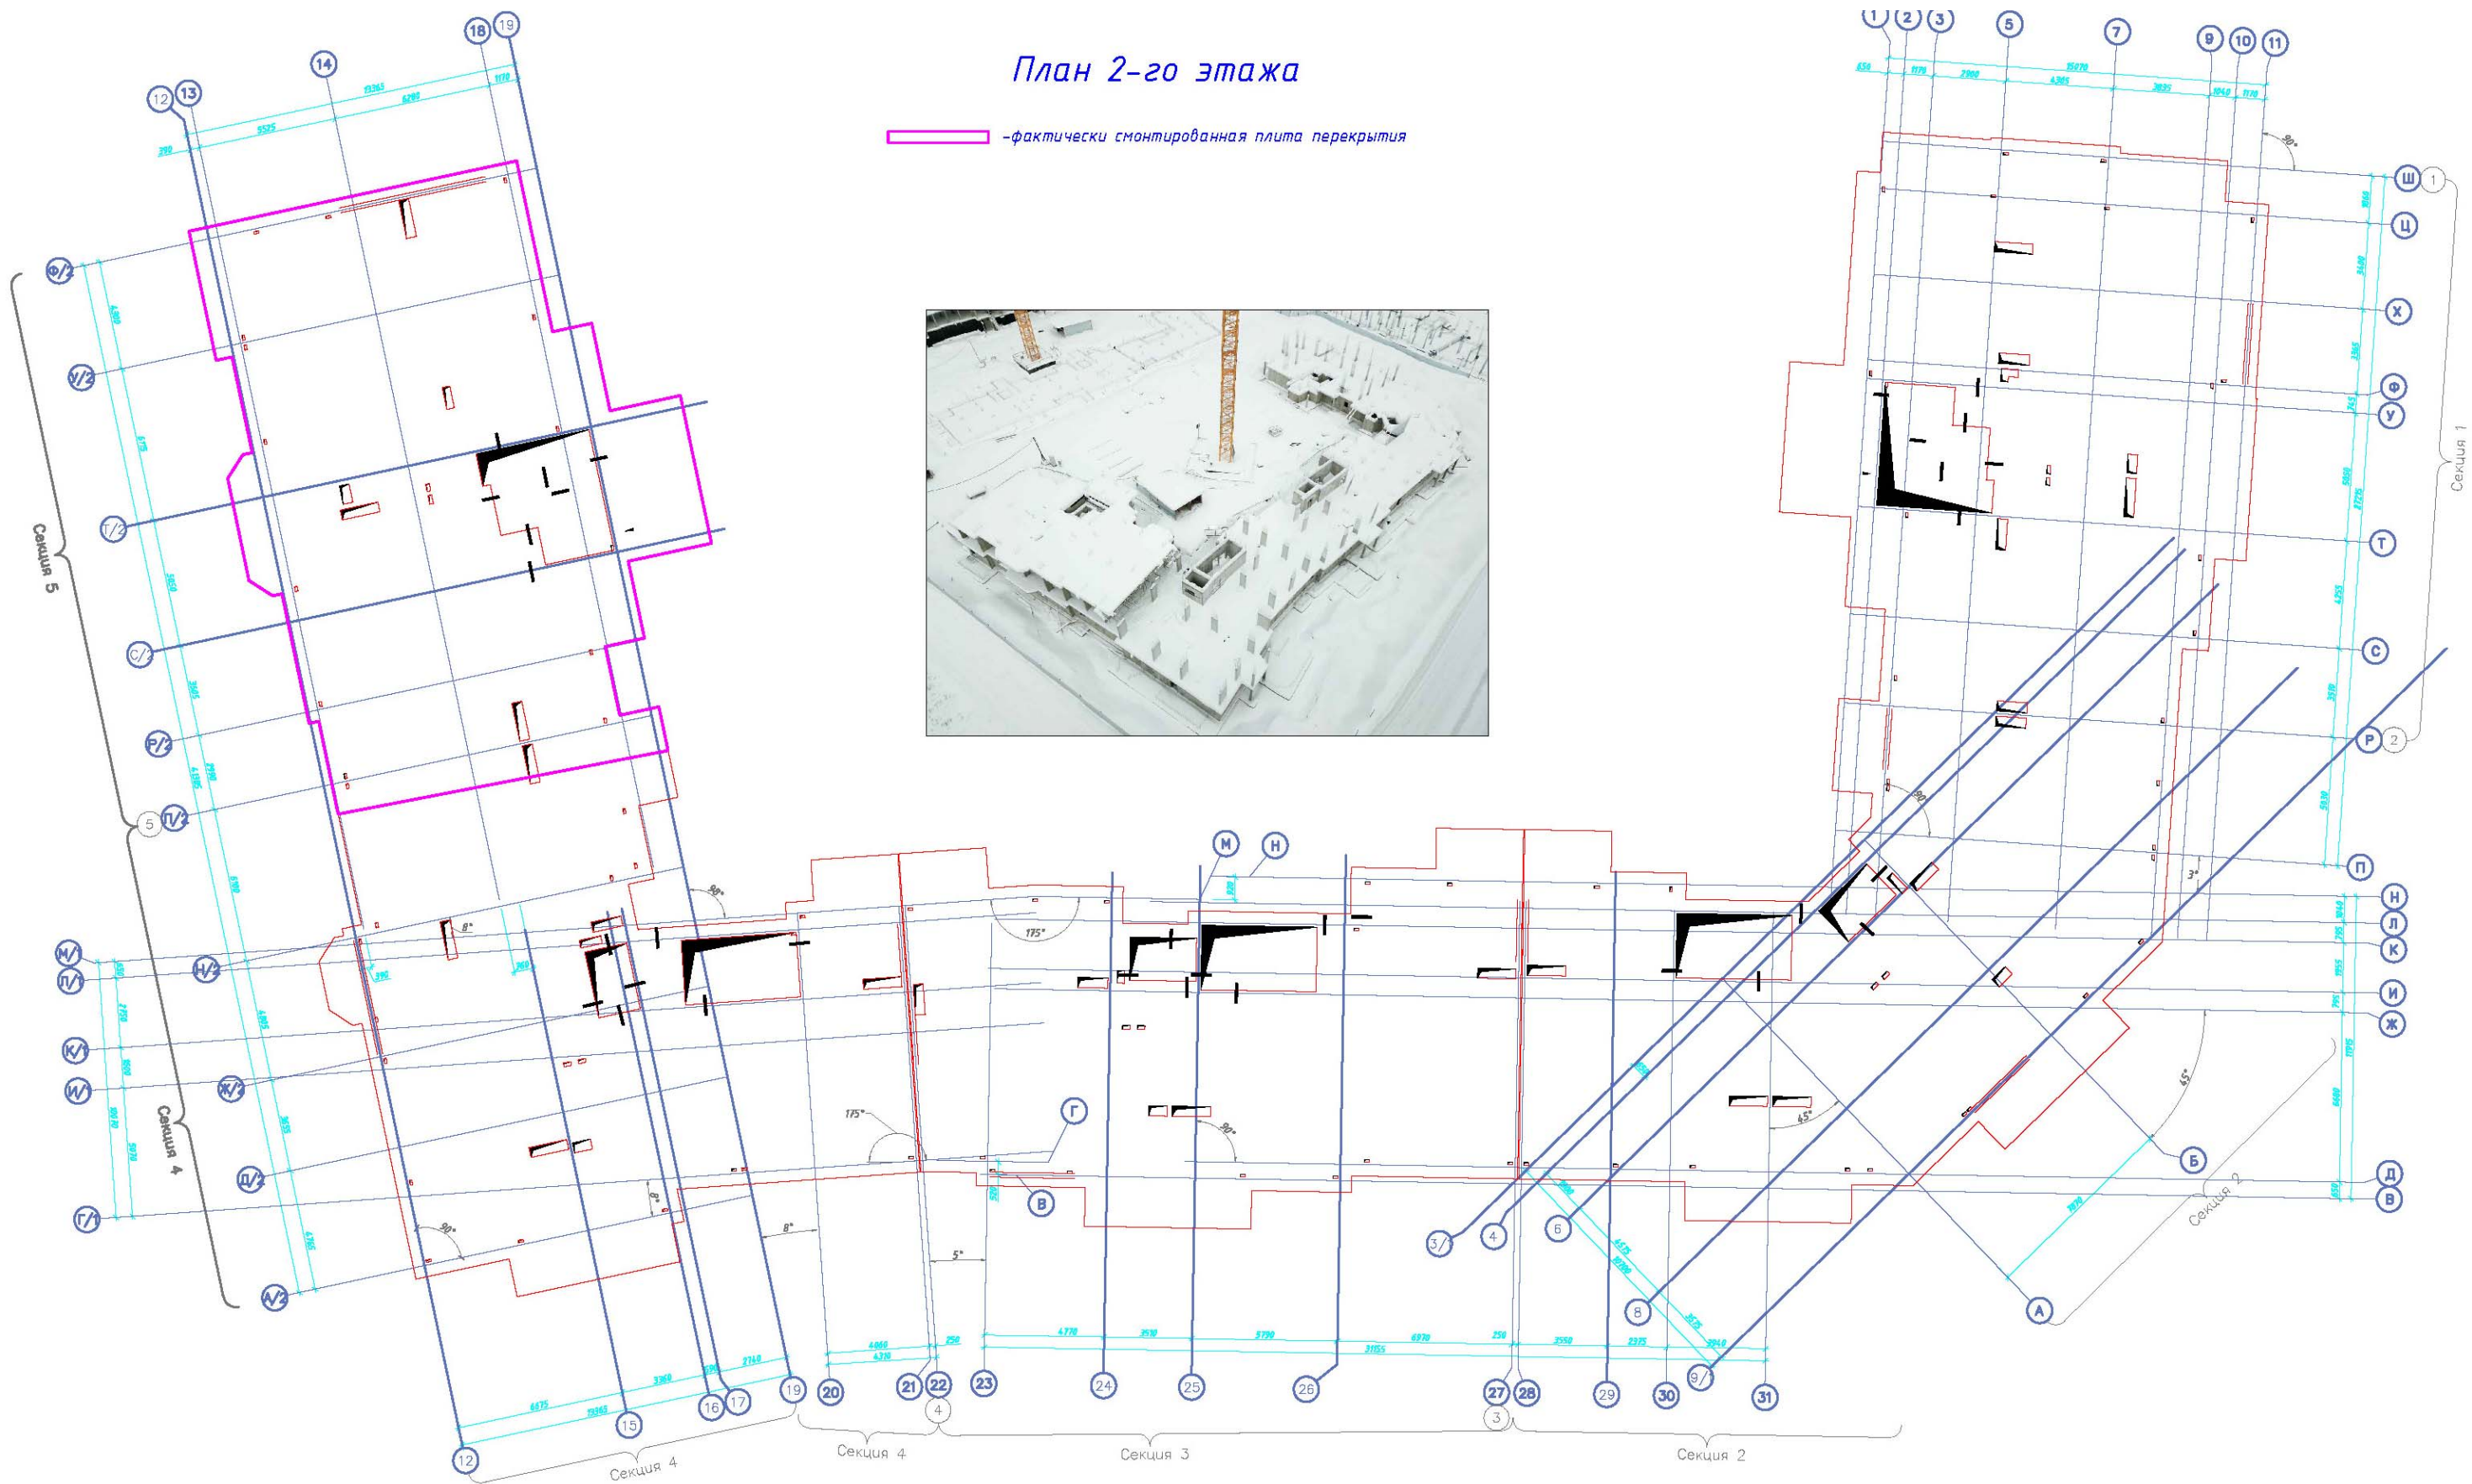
План фактически смонтированных конструкций 2-го этажа
